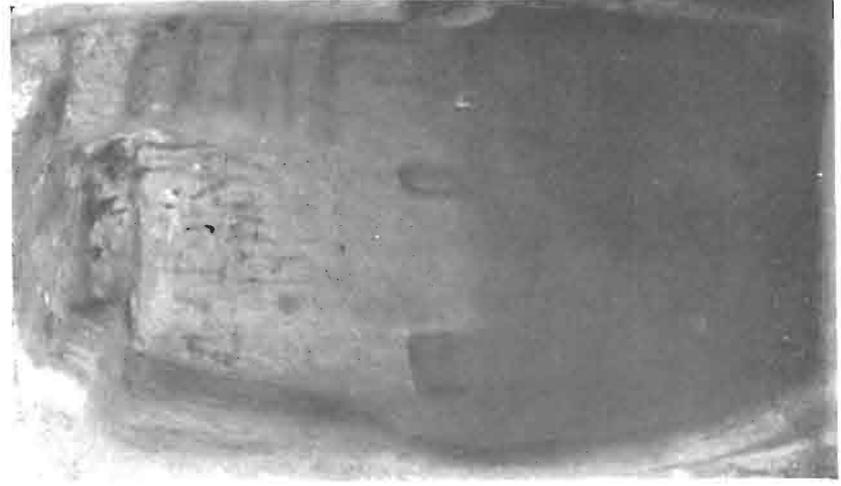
Arroyuelos. Fondo de la nave central con arranque de la escalera de acceso al piso superior.
